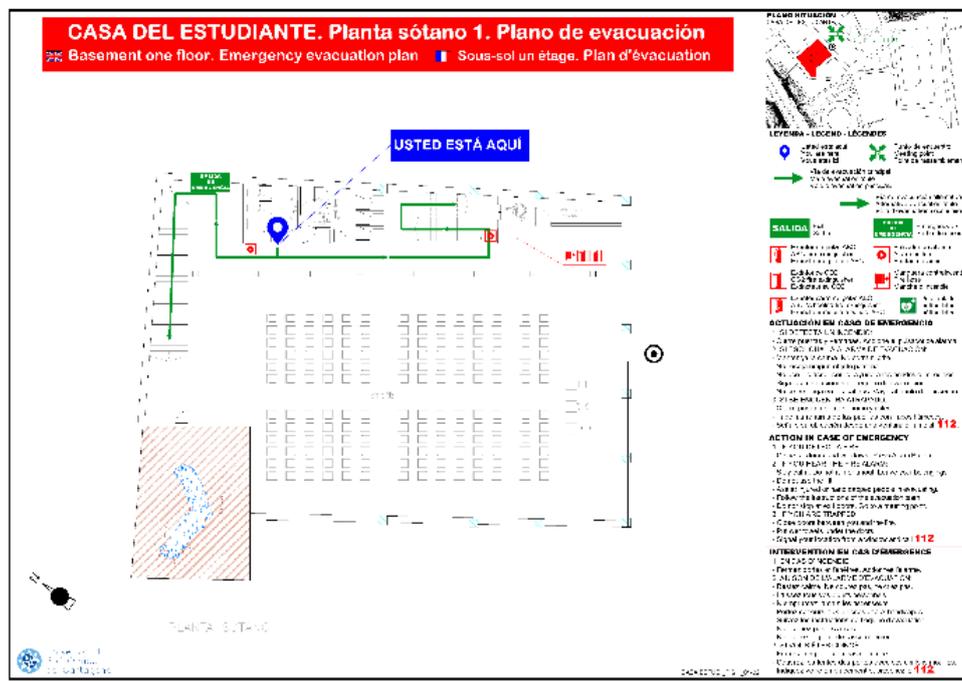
Plano de Evacuación de la Planta sótano del edificio Casa del Estudiante de la UPCT
